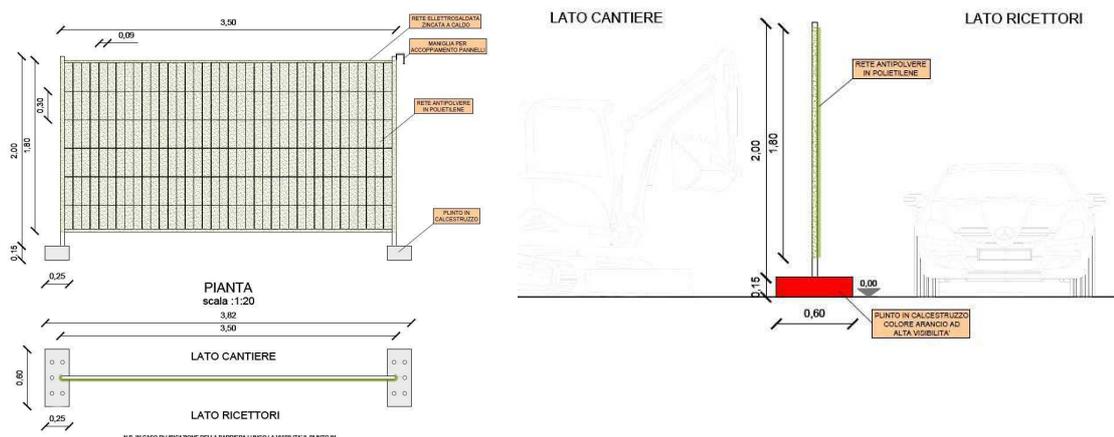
Barriera antipolvere: pianta prospetto e sezione
